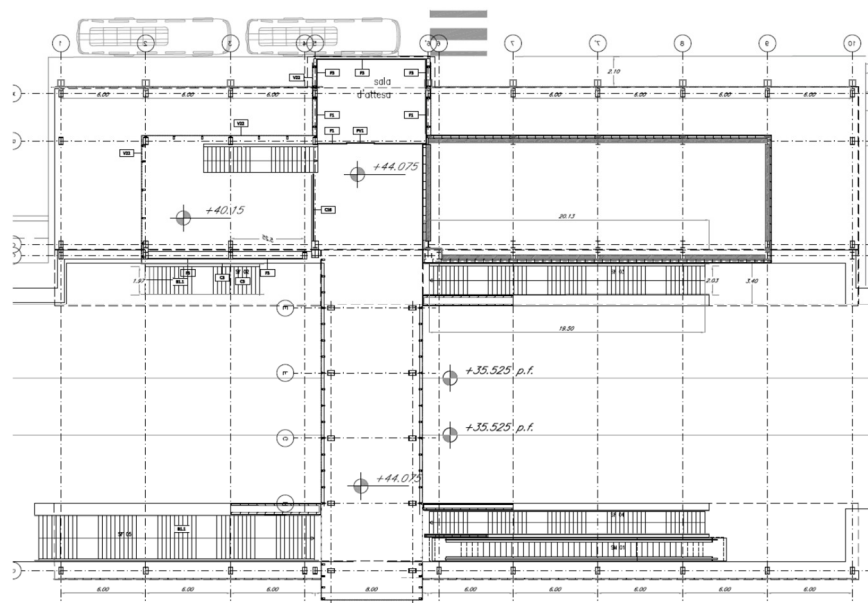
Planimetria della fermata di Campomarino piano sovrappasso
